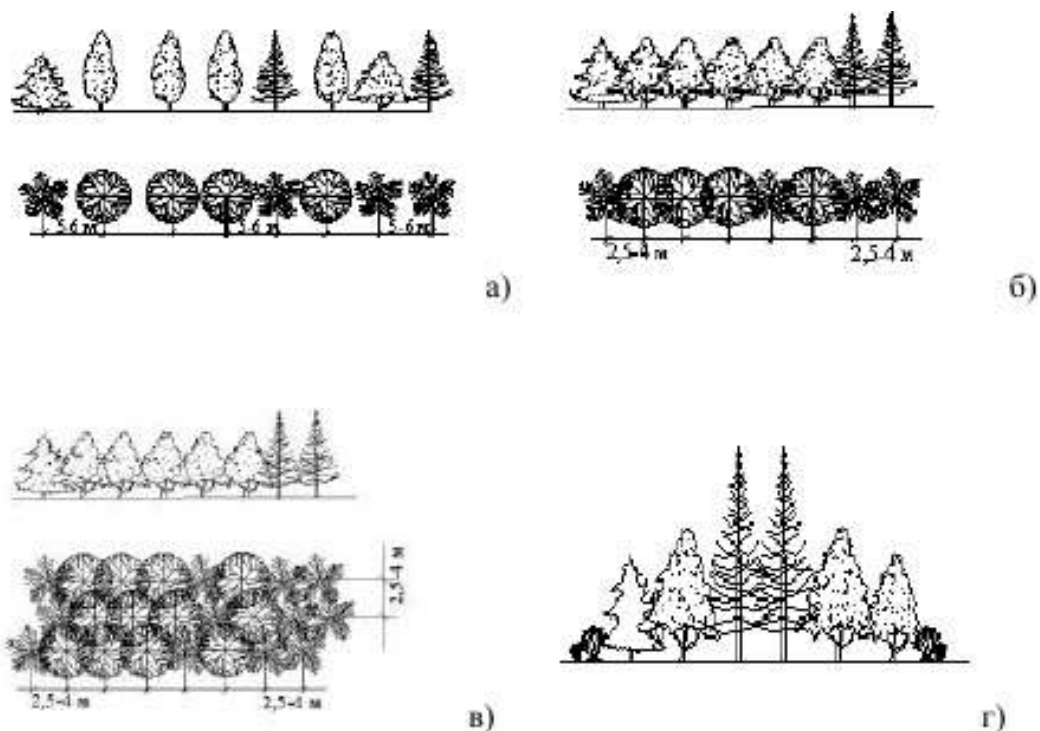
Вуличні посадки зелених насаджень: а) звичайна рядова посадка; б) шумозахисна посадка дерев; в) лінійна «шахова» шумозахисна посадка дерев; г) складна багатоярусна смуга дерев з лінійними посадками чагарників на опушці
